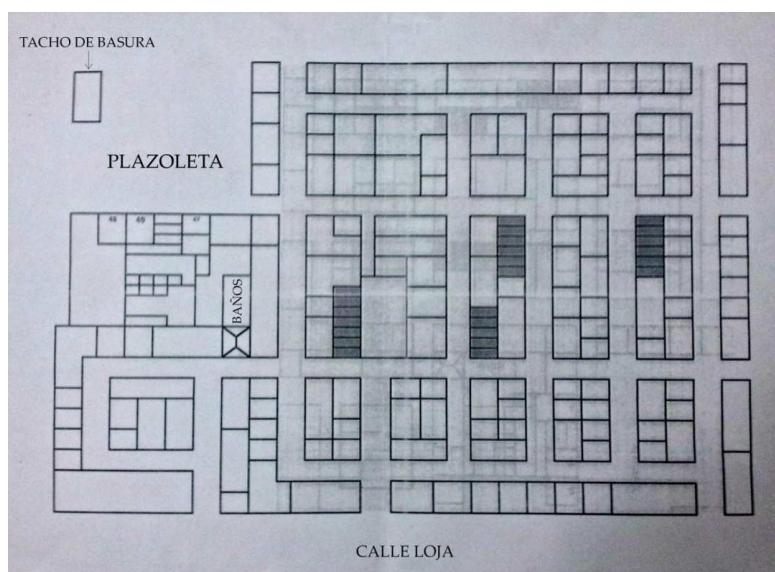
Plano de los locales de la planta baja del Mercado Artesanal.
